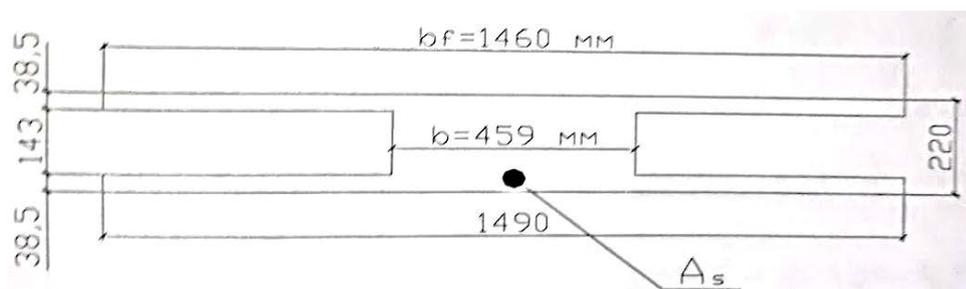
К расчету плиты перекрытия по предельным состояниям второй группы
